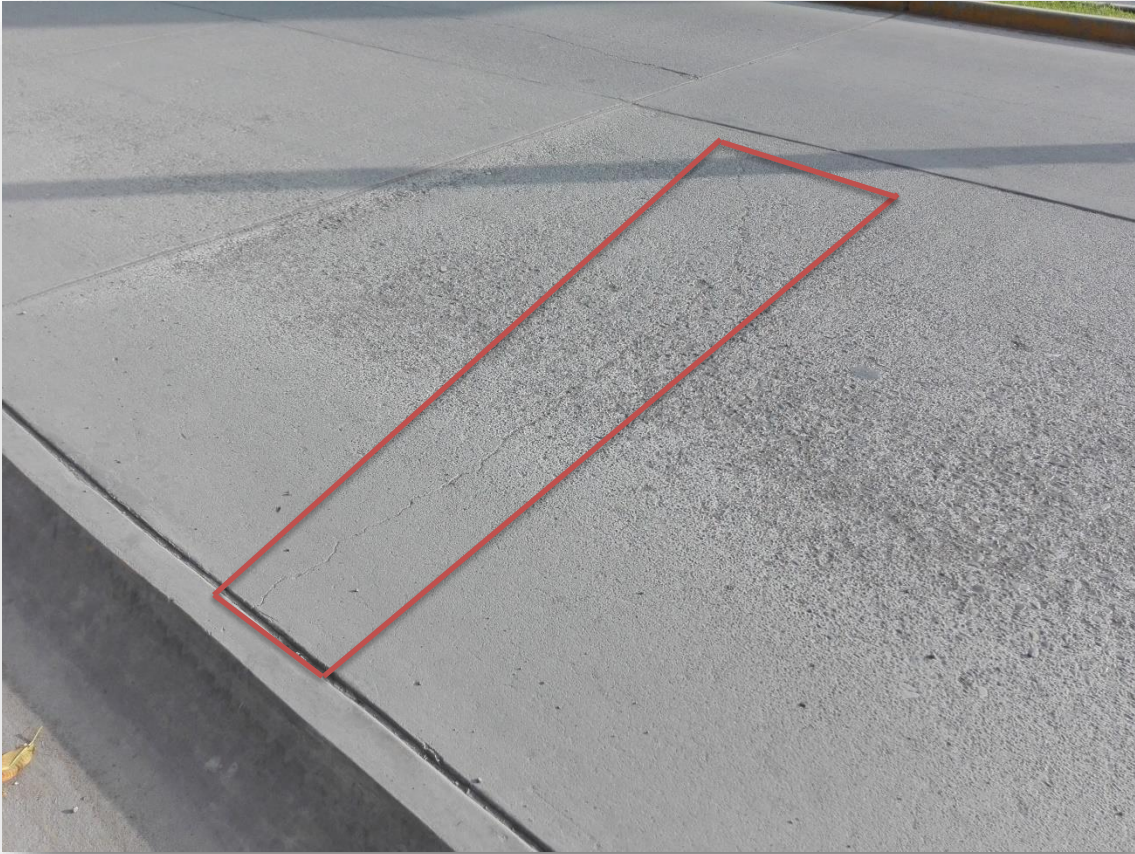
Fisura Descascaramiento y Fisuras Capilares
